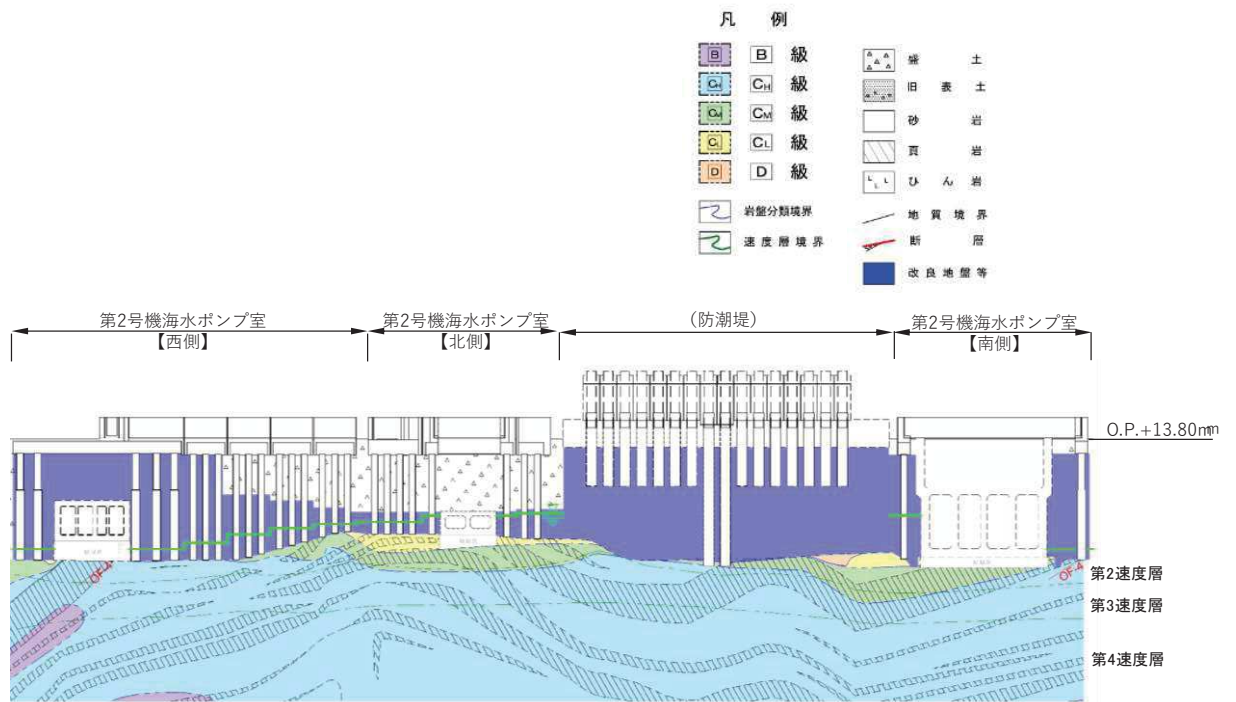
地盤改良体の配置図（防潮壁（第 2 号機海水ポンプ室），H-H 断面）
